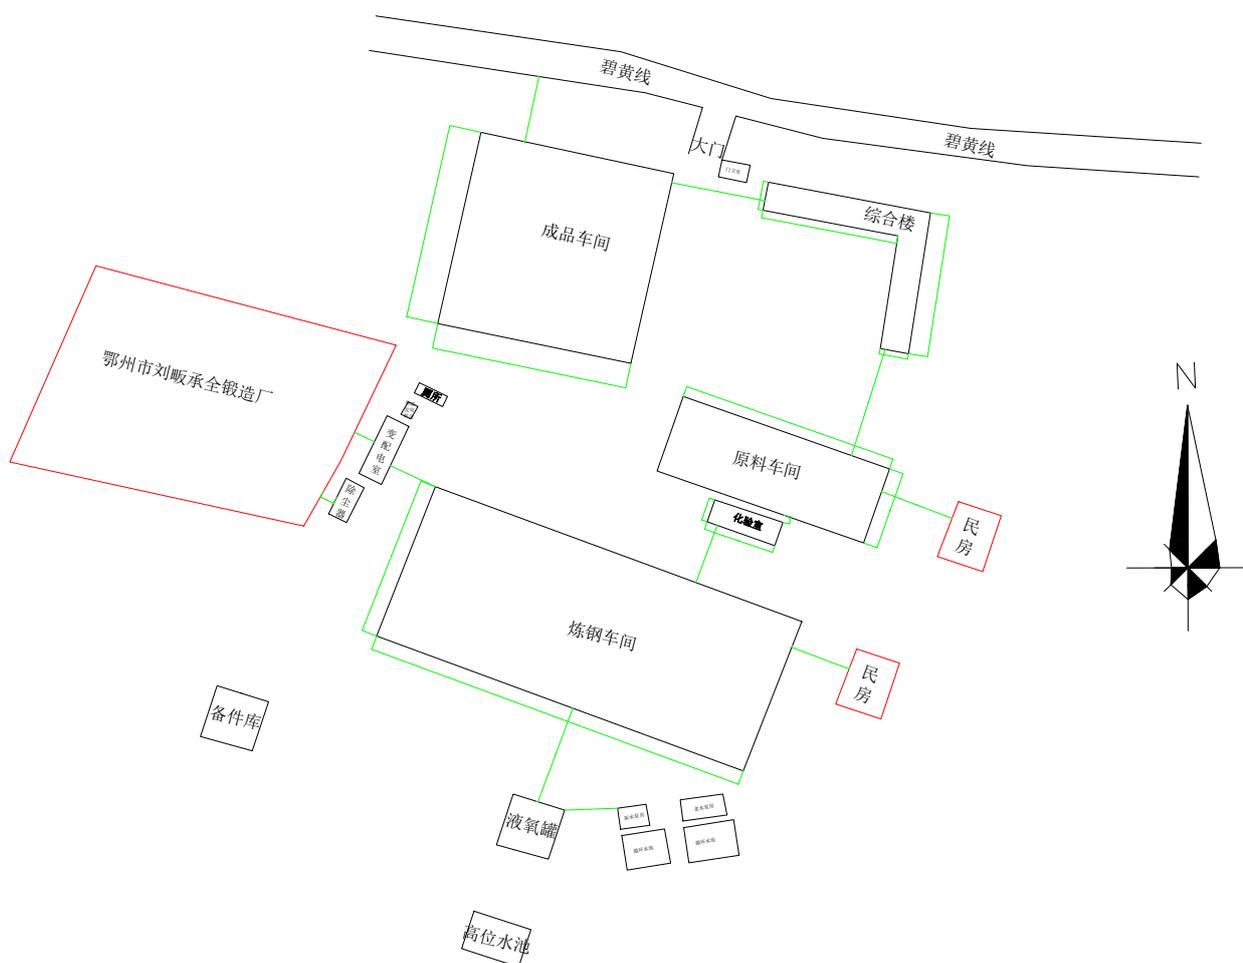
方圆特特钢年产 15000t 高合金模具钢项目总平面布置图
